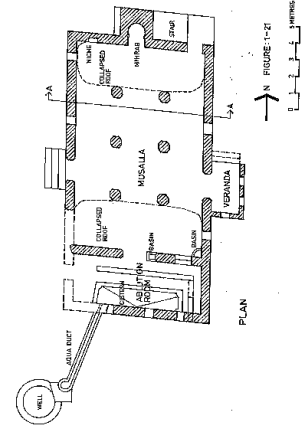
مسقط أفقي لمسجد كلوة الجامع/تنزانيا
